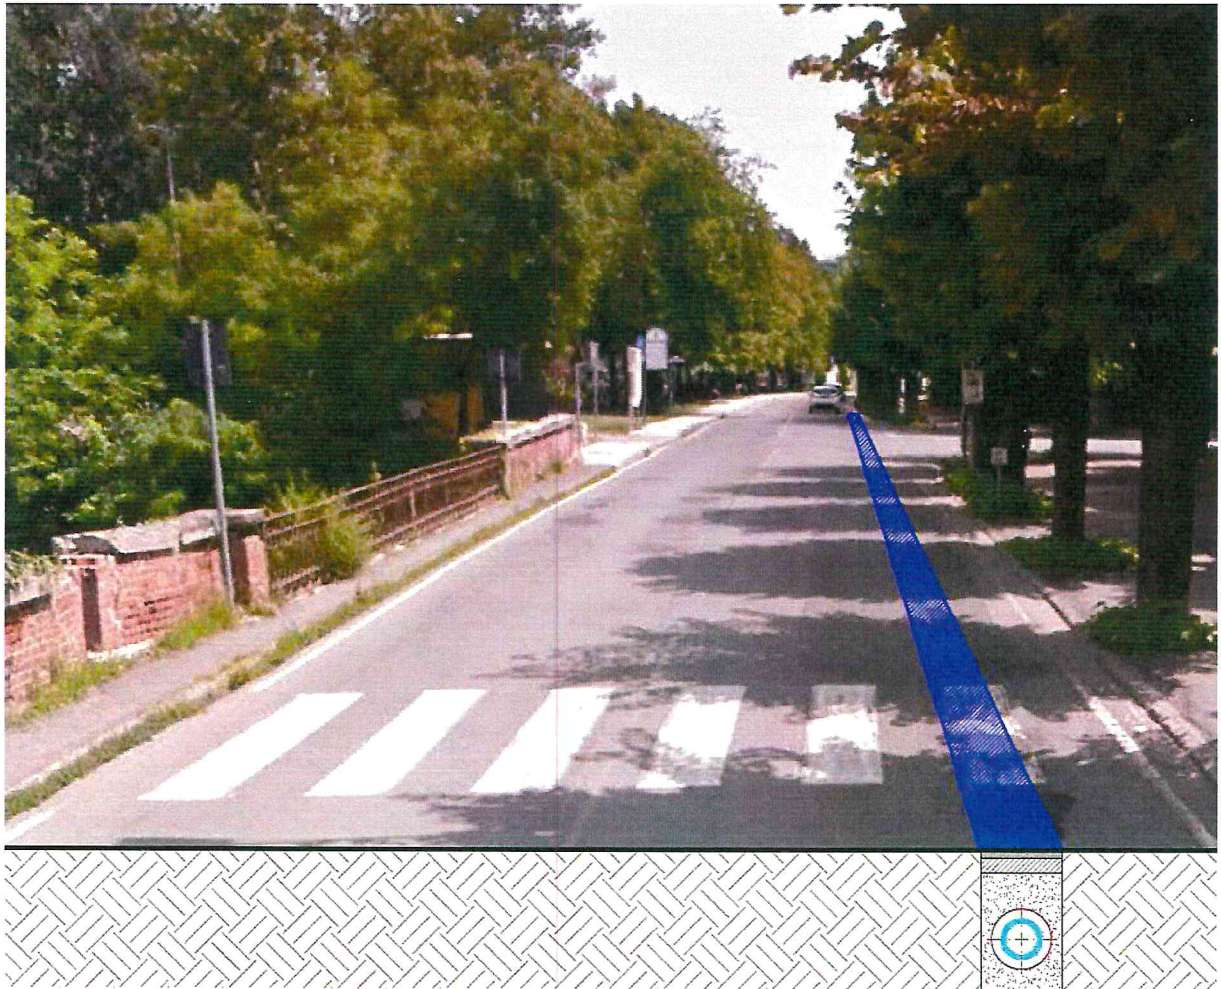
Viale Einaudi su ponte Rio Ravanasco – Vista direzione Visone – Stato di progetto
